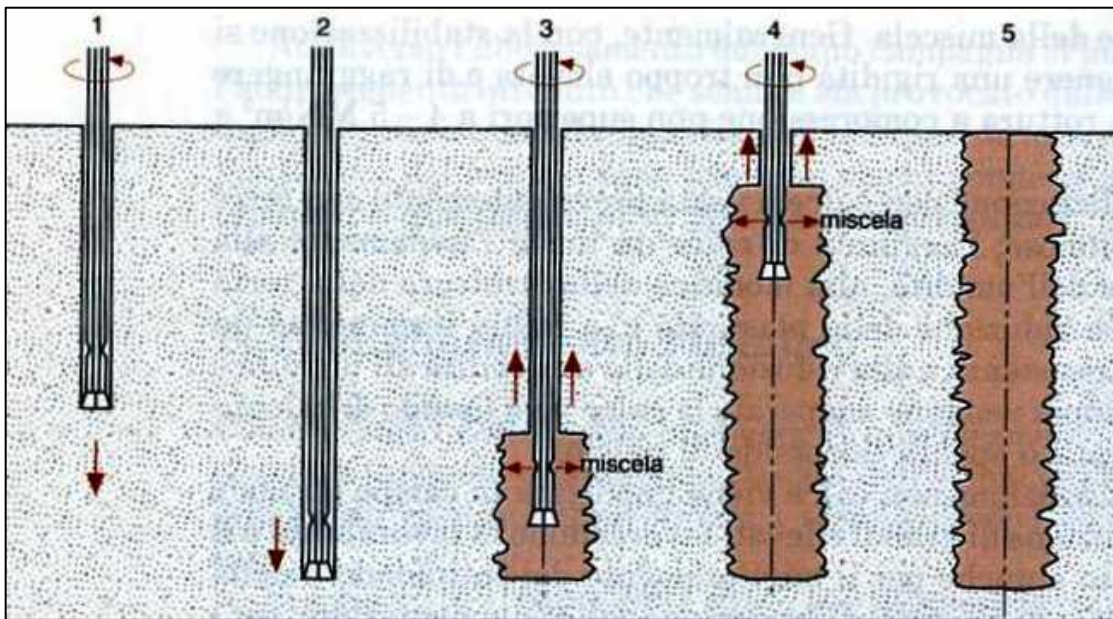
Schema di realizzazione colonna di jet-grouting monofluido
